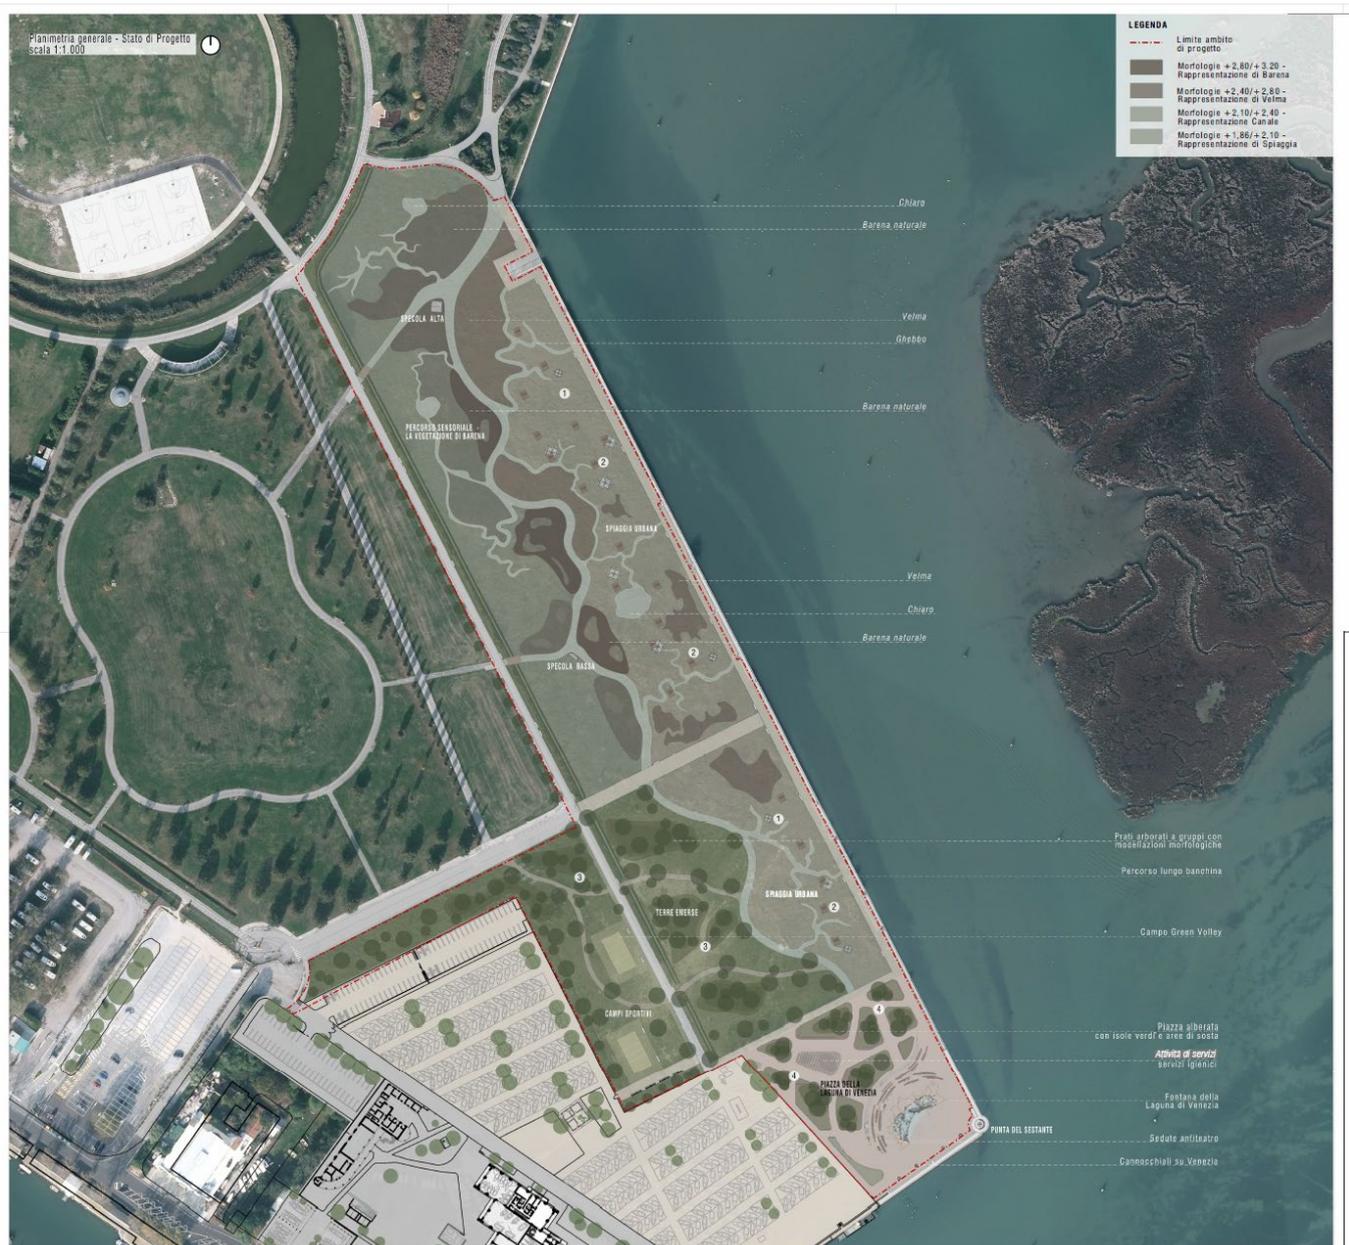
Planimetria generale prima fase con i soli interventi a terra
